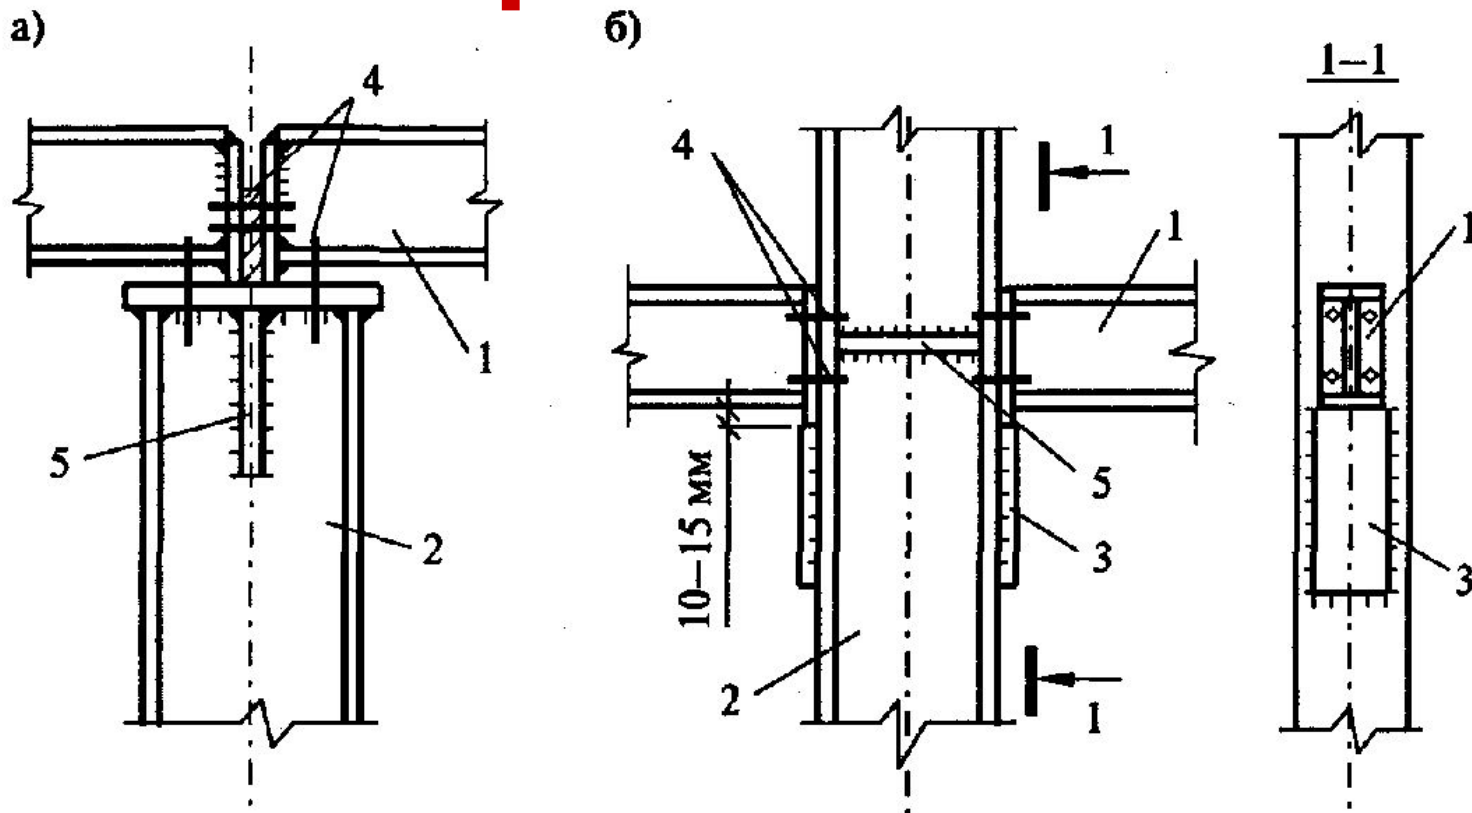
Шарнирное опирание балок на колонну: а) опирание на верх колонны; б) опирание на опорный столик; 1 — балка; 2 — колонна; 3 — опорный столик; 4 — болты; 5 — ребро жесткости
